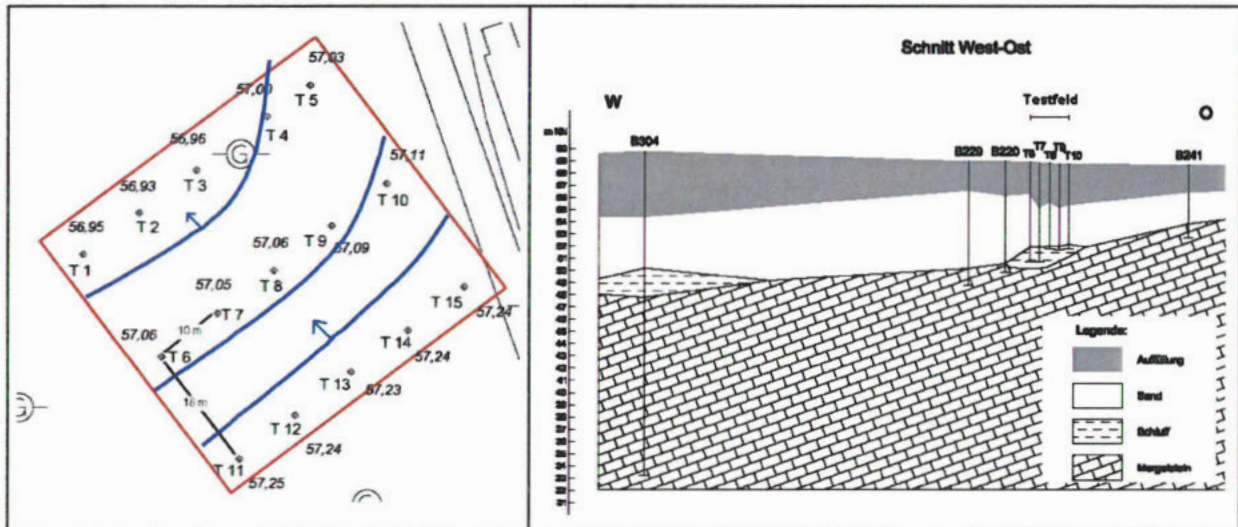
Lageplan Testfeld mit Pegeln und Grundwassergleichen
